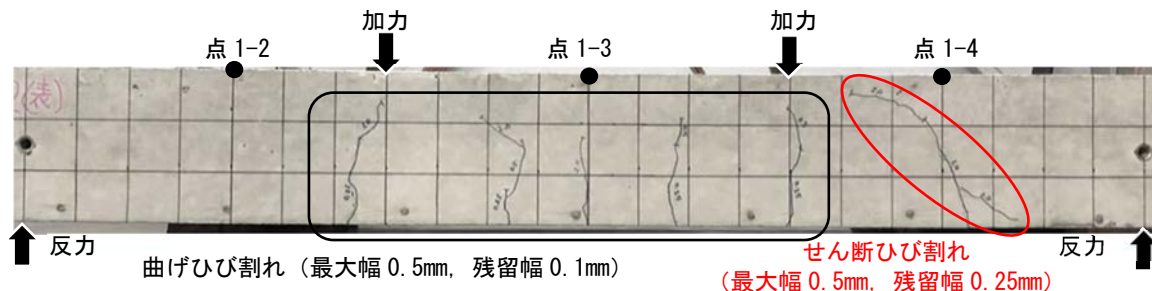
載荷実験終了後における平面部材側面のひび割れ状況
